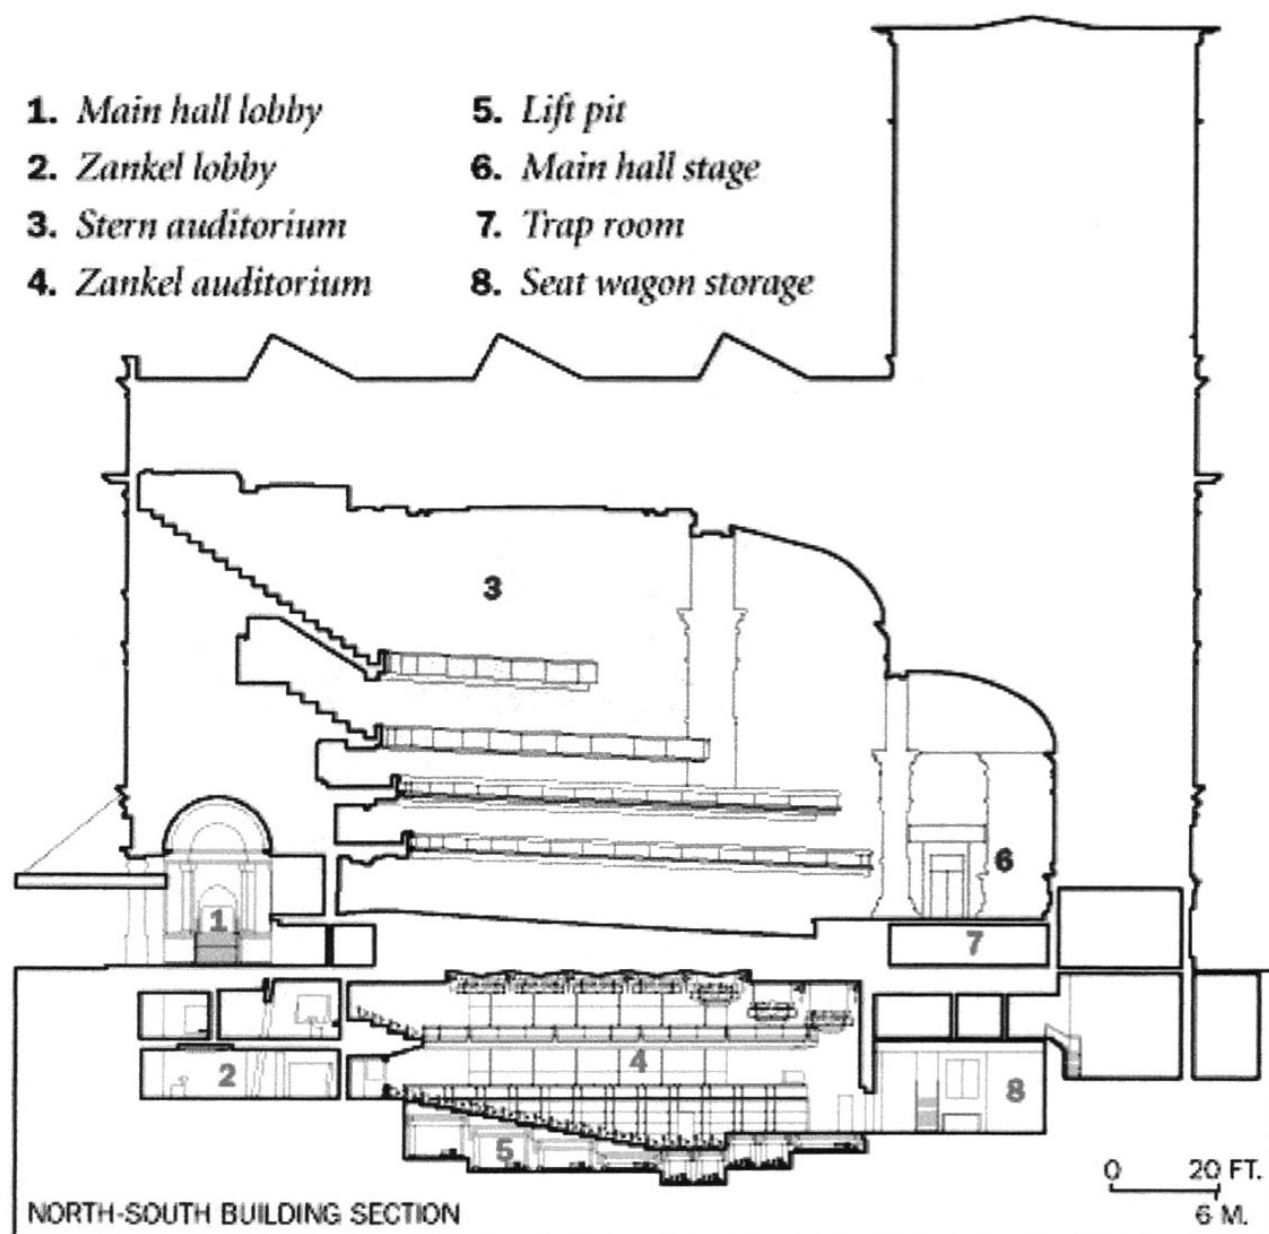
Разрез по зданию Carnegie Hall с подземным залом Zankel Hall
